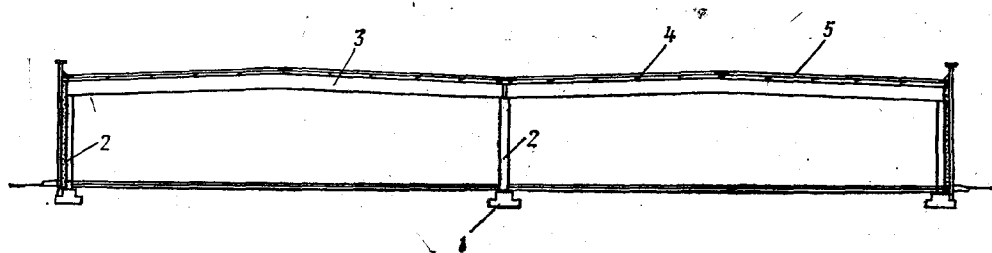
Стальной каркас из прокатных и сварных профилей:
